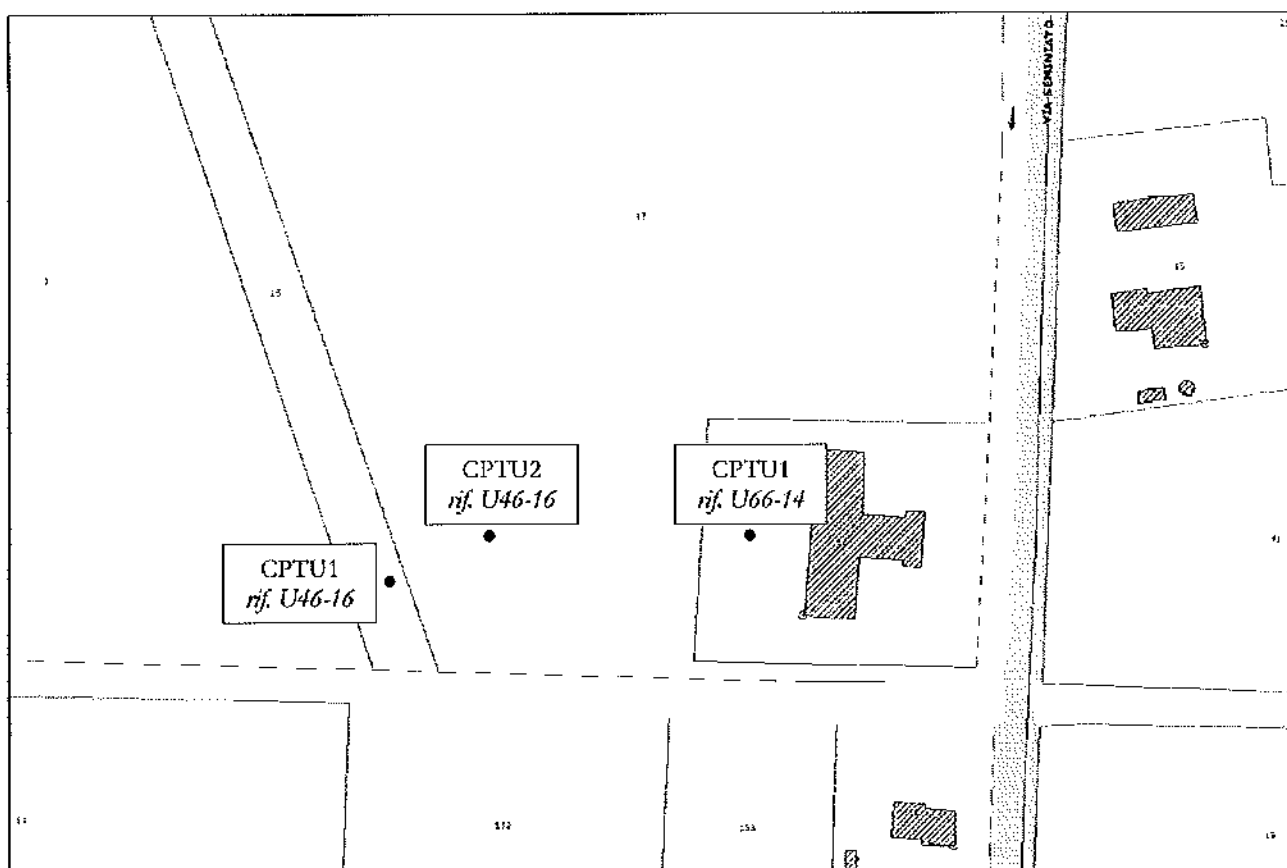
Planimetria catastale generale con ubicazione delle prove.
